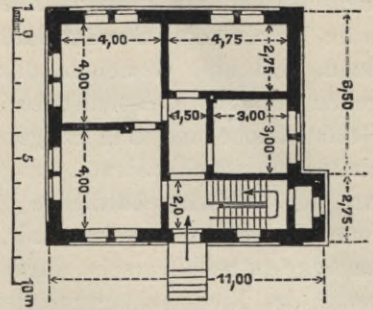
Grundriß des Wohngebäudes für den Maschinenmeister an der Talsperren- und Elektrizitätsanlage der Stadt Solingen.
